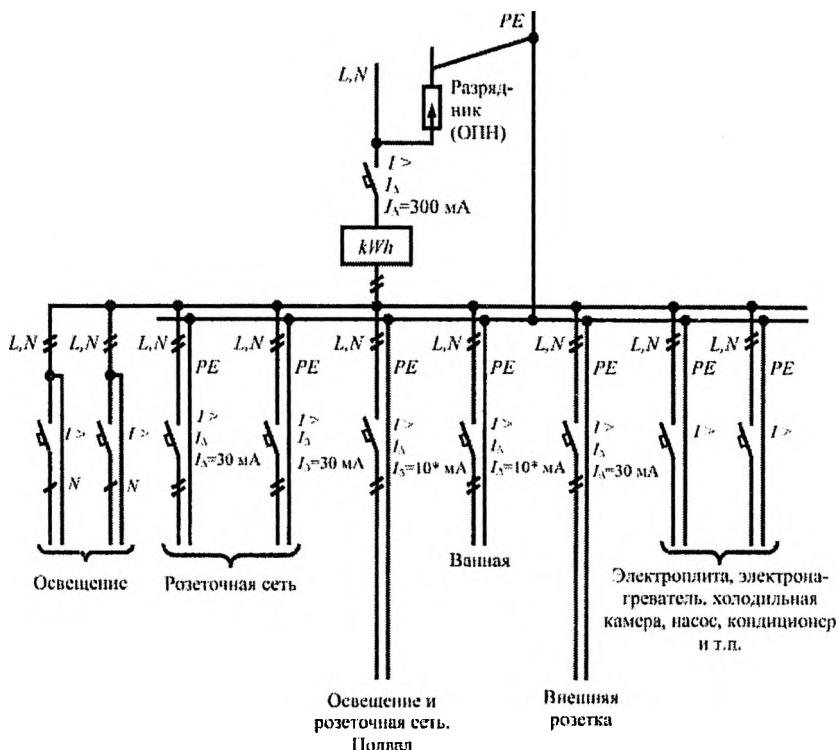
Схема электроснабжения индивидуального дома по схеме TN-C-S
